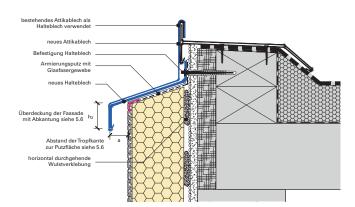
Beispiel einer Attikaverbreiterung an vorhandener unveränderbarer Altbau-Attika (Dachrandabschluss) mit hochgeführter Dachabdichtung und Metallabdeckung
